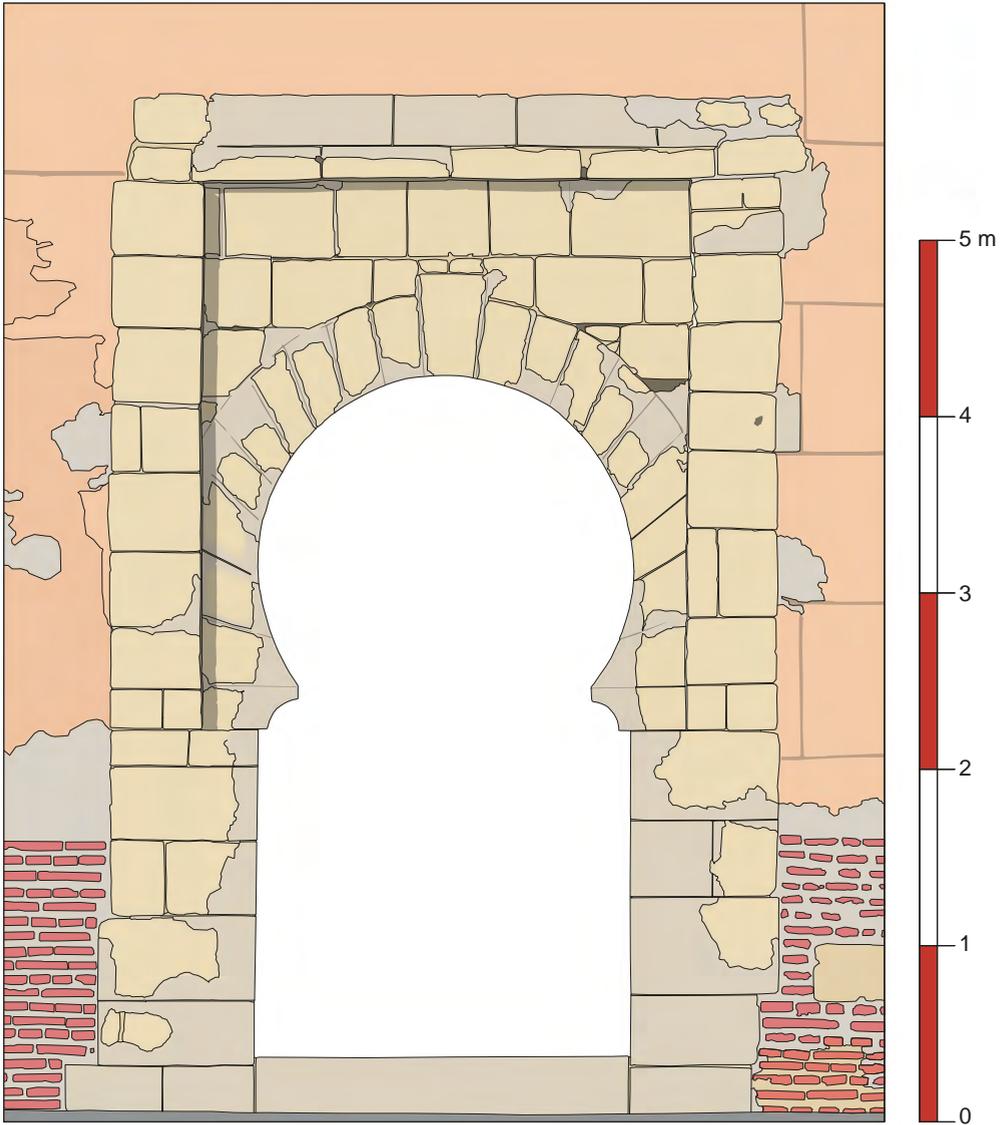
Puerta de Córdoba, en Sevilla. Fachada interior.
